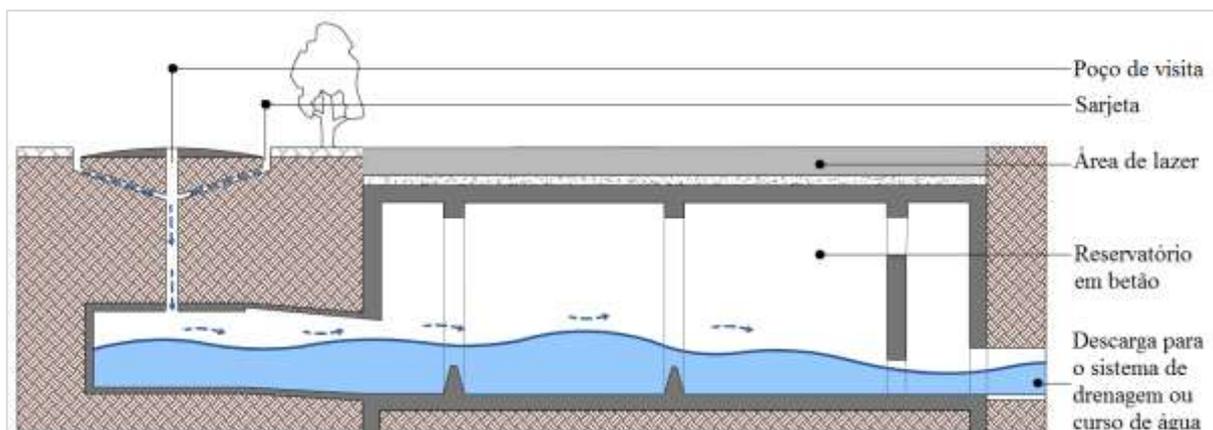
Estrutura de uma bacia de retenção subterrânea
